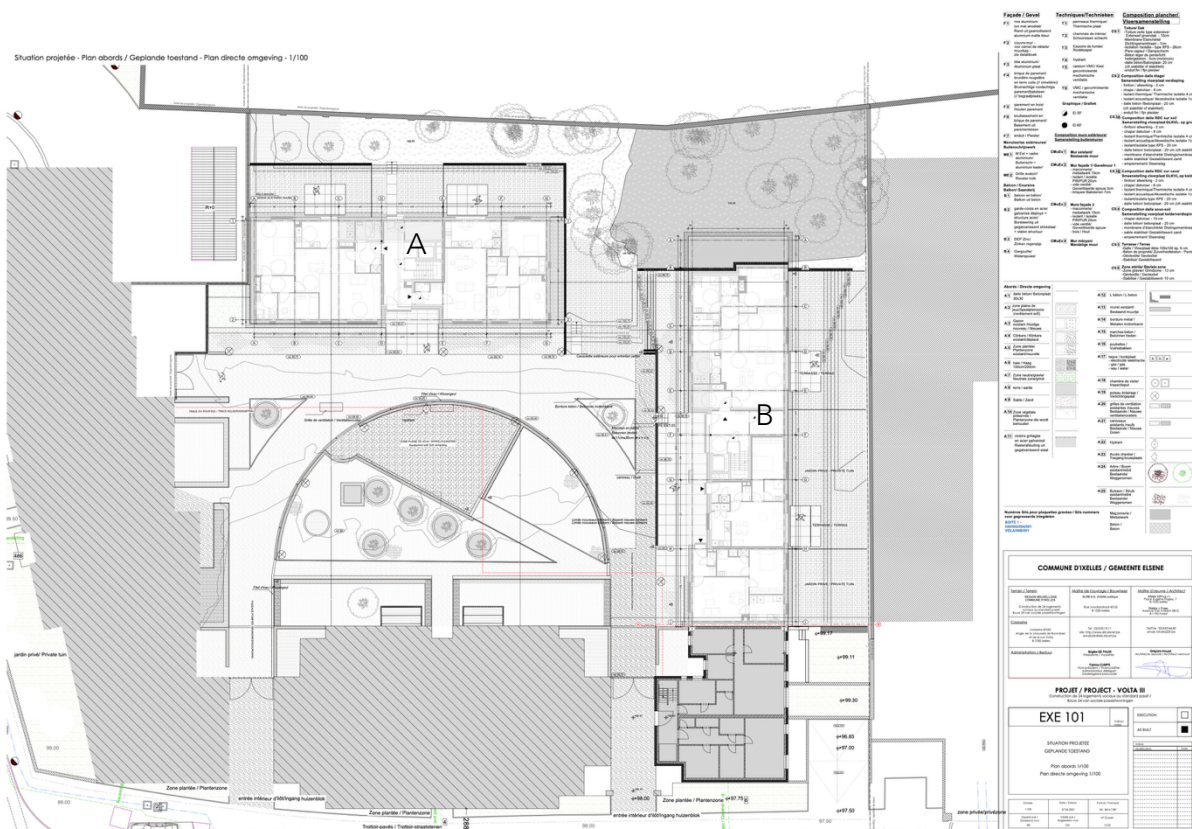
Plan de la situation projetée (BinHôme, 2021)
